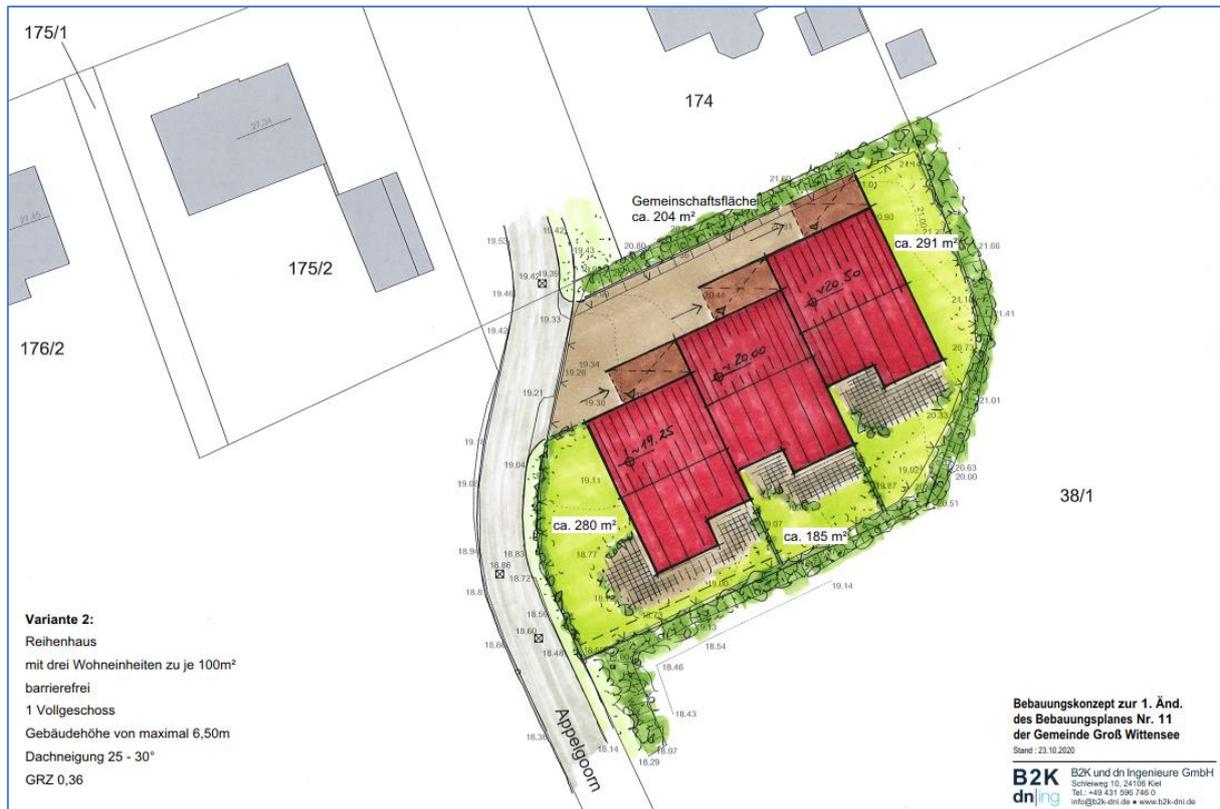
Bebauungskonzept der geplanten Bebauung, B2K und dn Ingenieure (2020)
